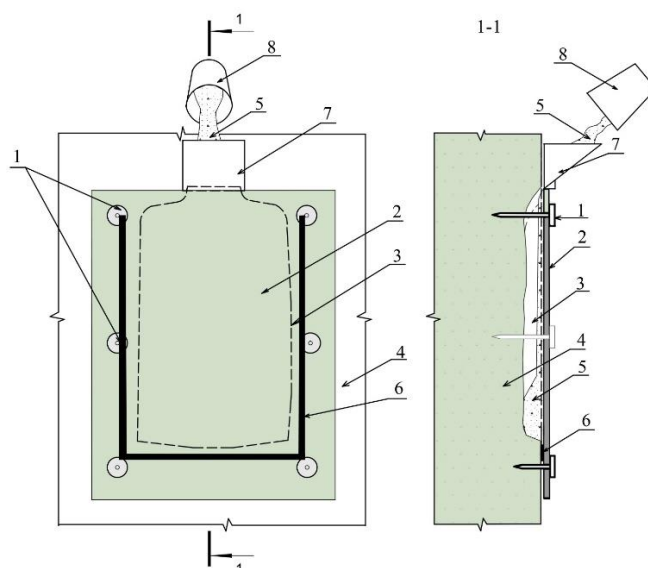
Вкладання ремонтної суміші в опалубку вручну при відновленні бокових поверхонь вертикальних конструкцій: 1 – анкерні кріплення; 2 – опалубка; 3 – відновлювана ділянка; 4 – залізобетонна конструкція; 5 – ремонтна суміш; 6 – ущільнювач; 7 – приймальний лоток, 8 – ємність з розчином
